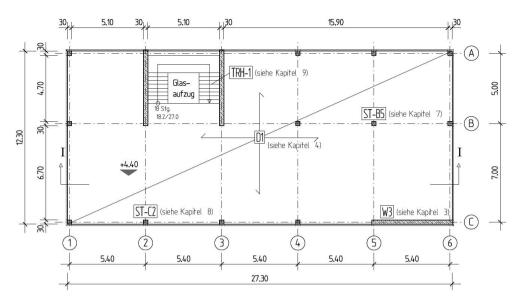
Grundriss im Regelgeschoss
